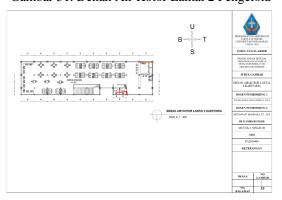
Denah Air Bersih Lantai 2 Kafetaria
